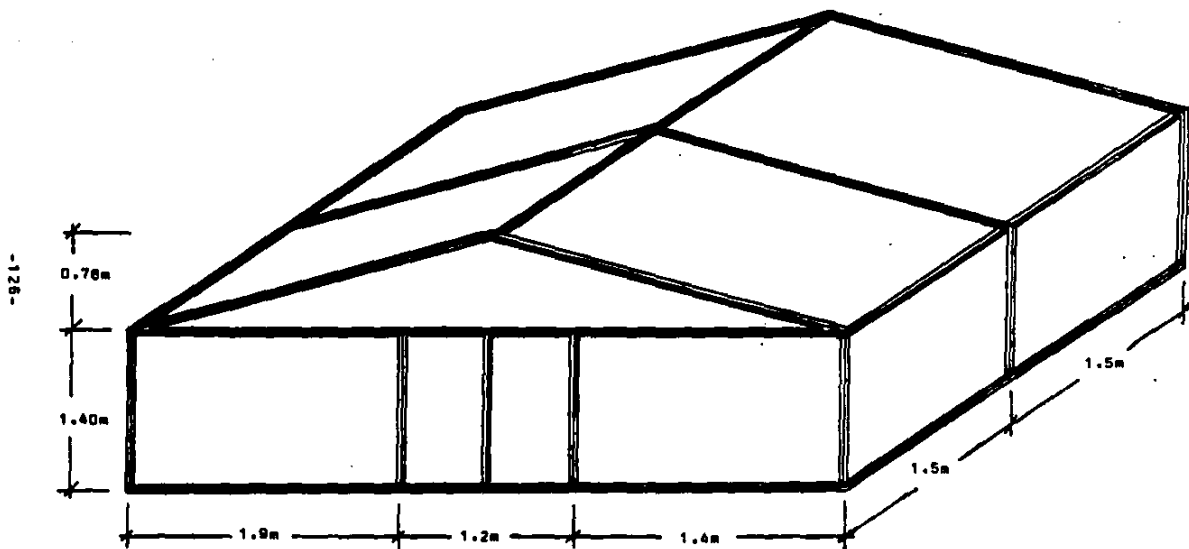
ESTRUCTURA DEL INVERNADERO PROPUESTO
